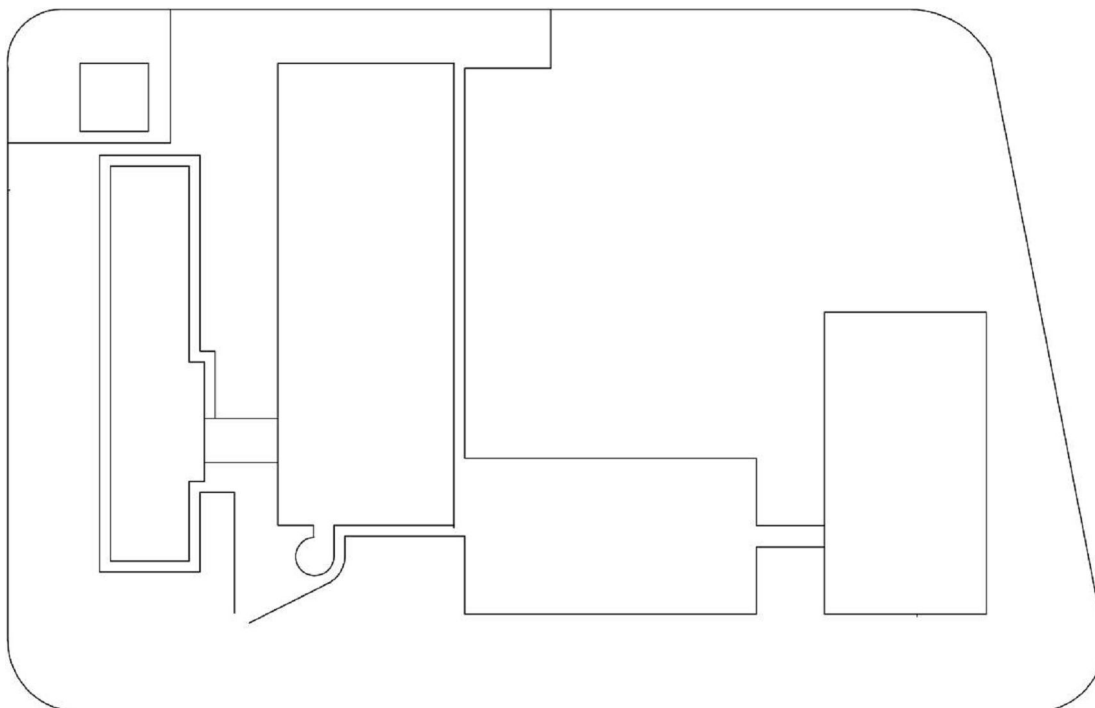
Planta Baixa encontrada no Acervo do estado referente a uma escola.
